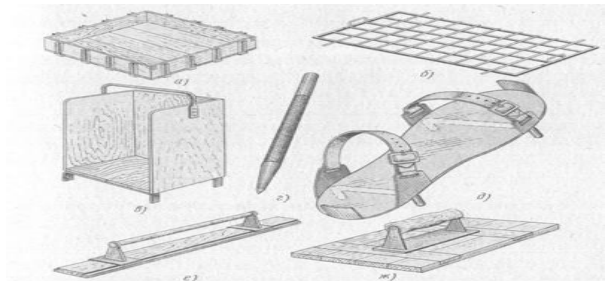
Инвентарь и приспособление для укладки плиточных полов: а — емкость для приема раствора, б — плиточный шаблон, в — контейнер для плитки, г — стальной штырь, д — подножка, е — деревянный полутерок, ж — хлопуща
